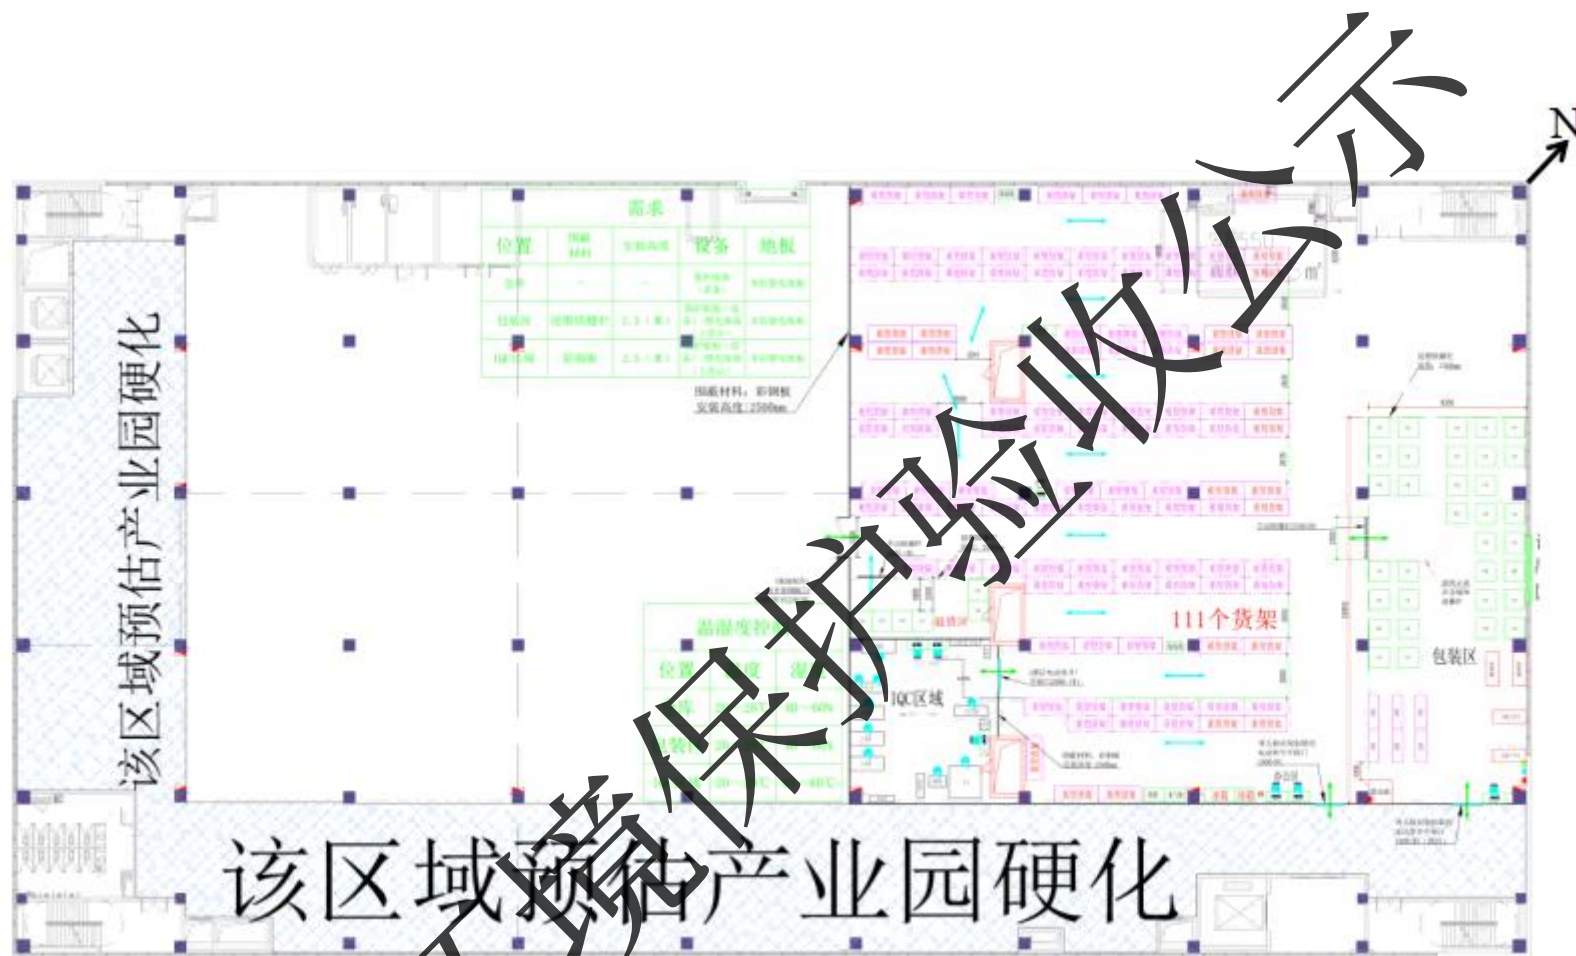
(2) 平面布置图 (仓库: 2#厂房 3F 一单元)
